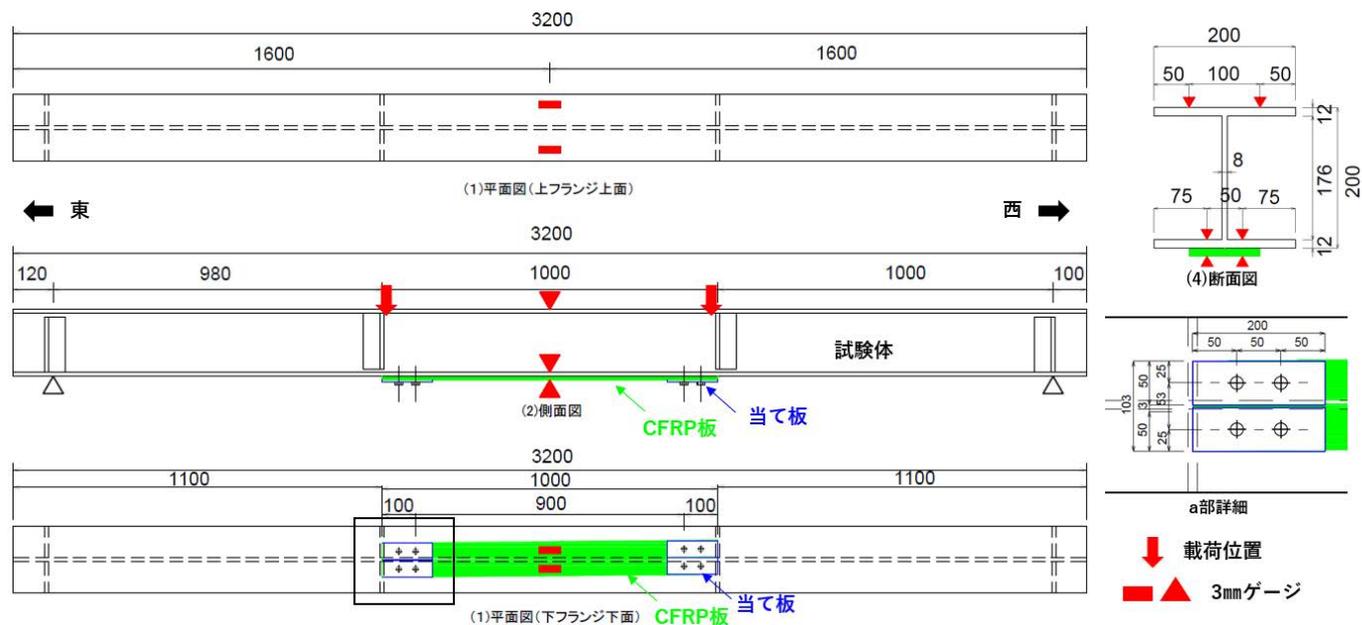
試験体の形状と寸法および載荷位置、ゲージ位置
